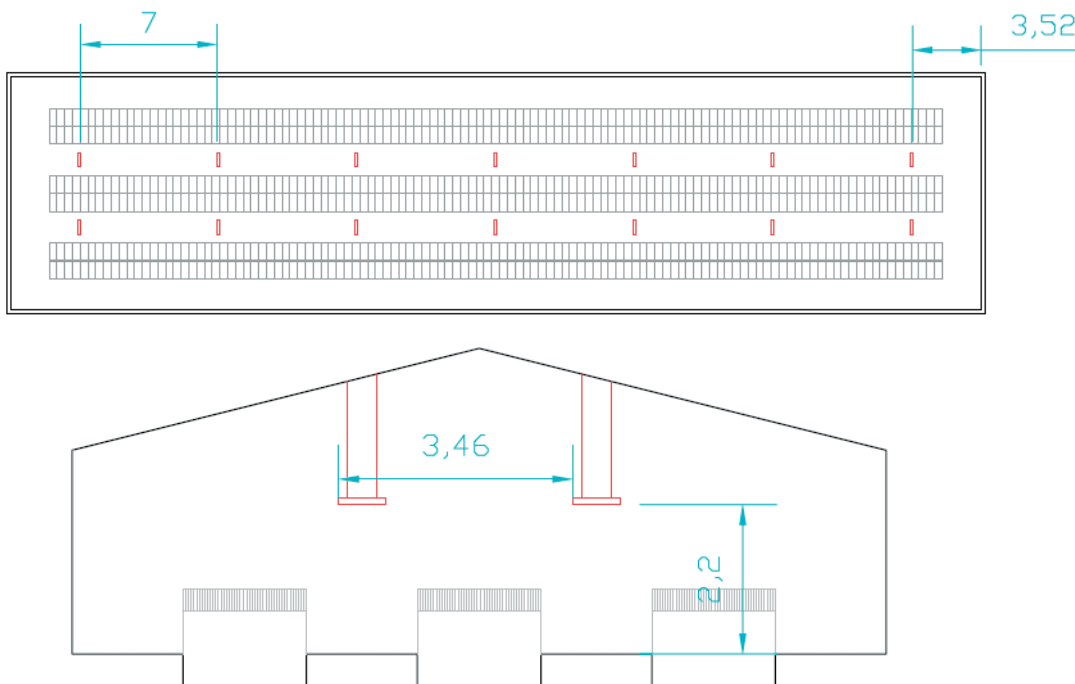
Planta y sección de la instalación de alumbrado de la nave de engorde.
